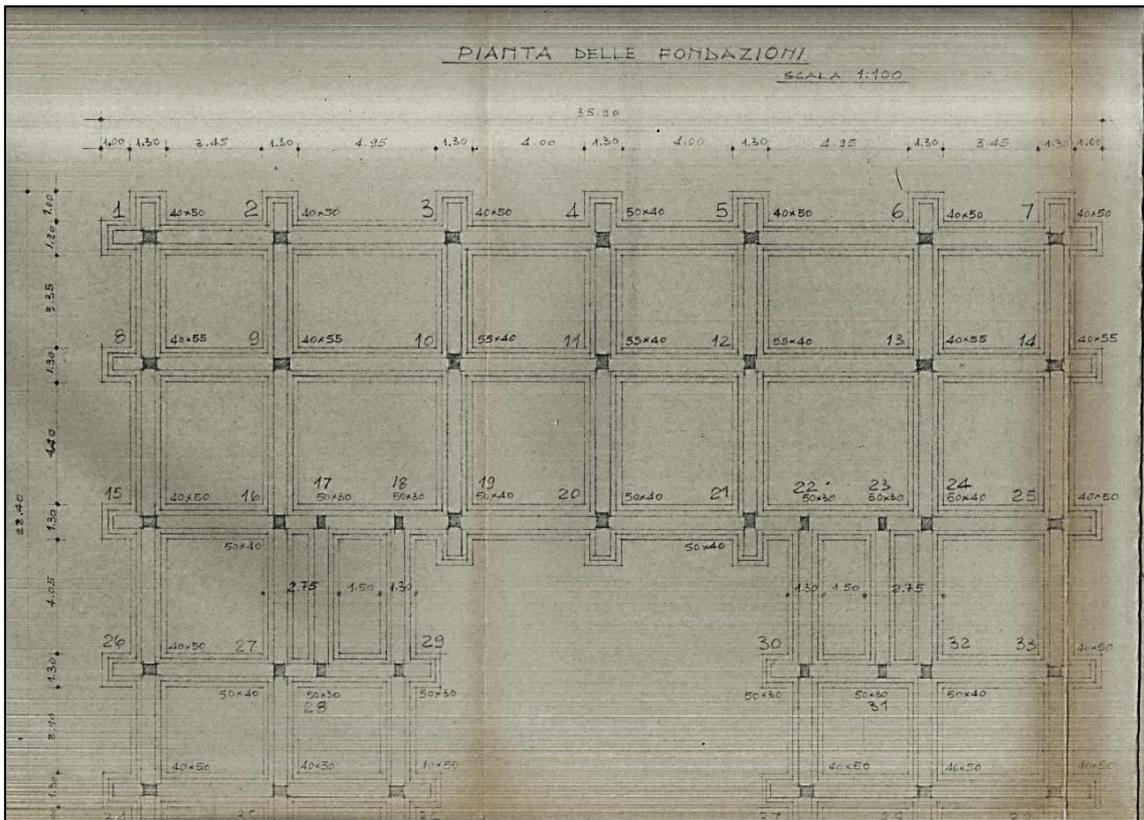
Pianta delle fondazioni reperita dall'archivio del Genio Civile
